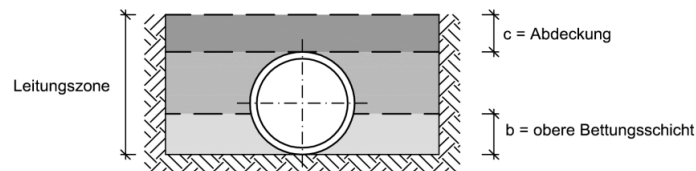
Ausführung der Bettung nach DIN EN 1610.
